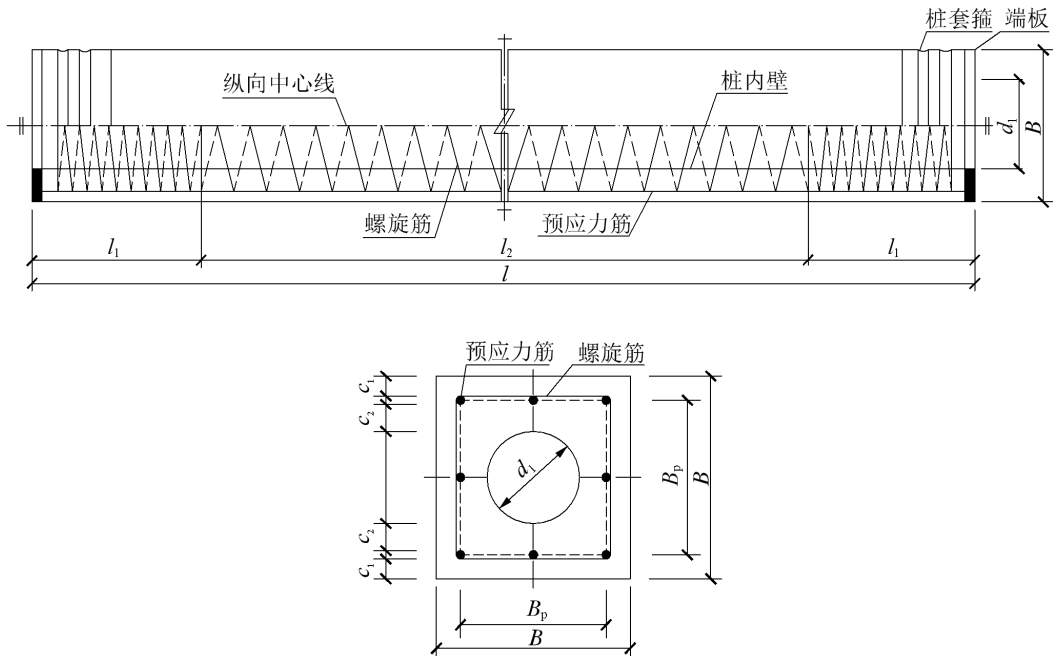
预应力高强混凝土空心方桩、预应力混凝土空心方桩结构形式
